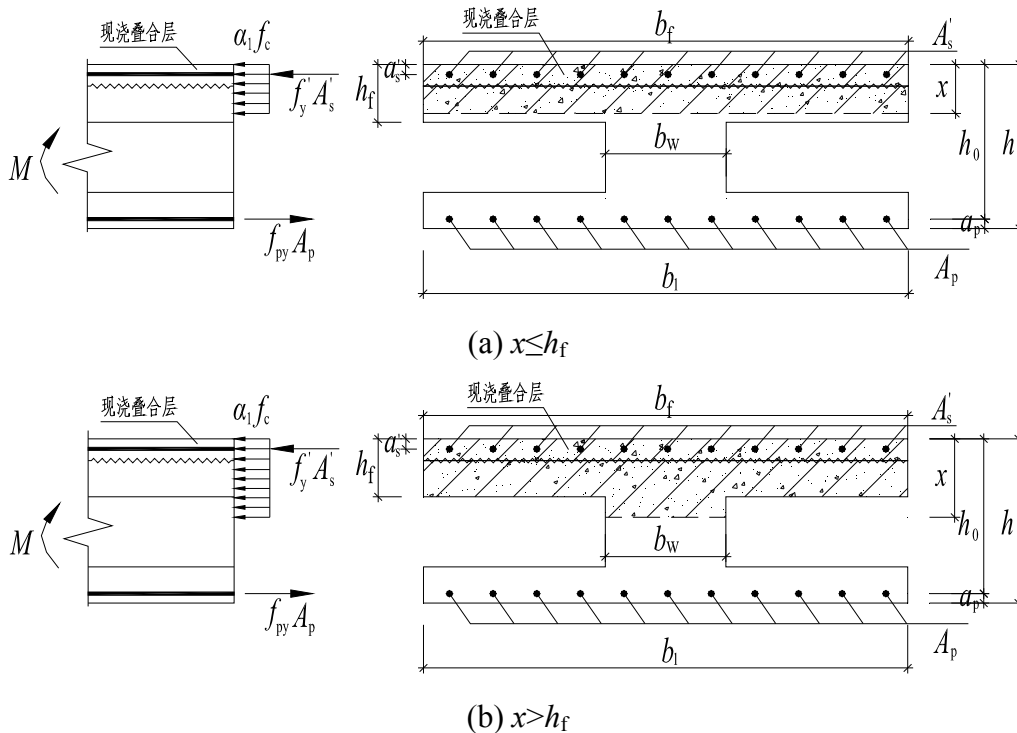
预应力混凝土空心叠合板正弯矩区正截面受弯承载力计算
